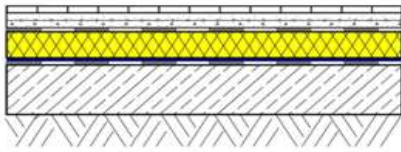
Утеплення підлоги по бетонному перекриттю [32]
